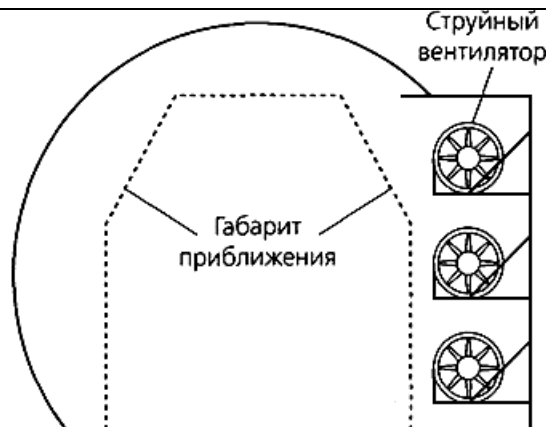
Размещение струйных вентиляторов в нише, выполненной в стене тоннеля
